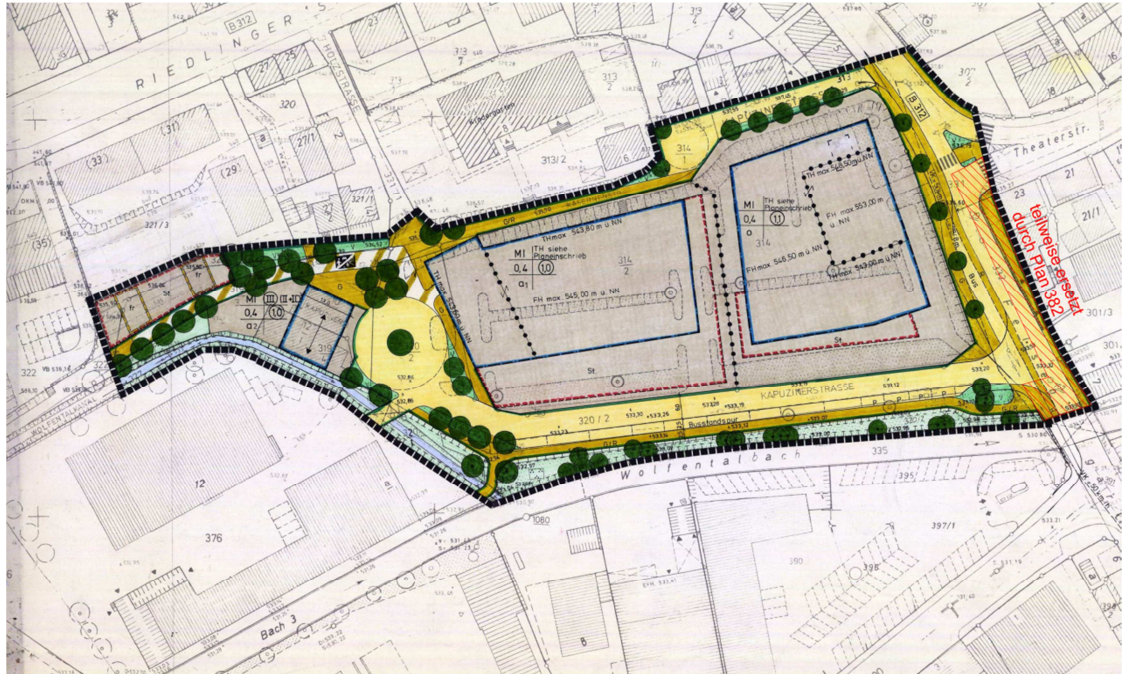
Auszug Bebauungsplan „Kapuzinerstraße“ (Plan 306), Stadt Biberach 16.02.1990
